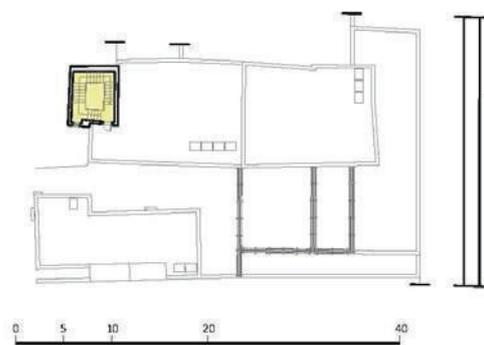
Pianta piano secondo e terzo, destinazioni d'uso attuali
